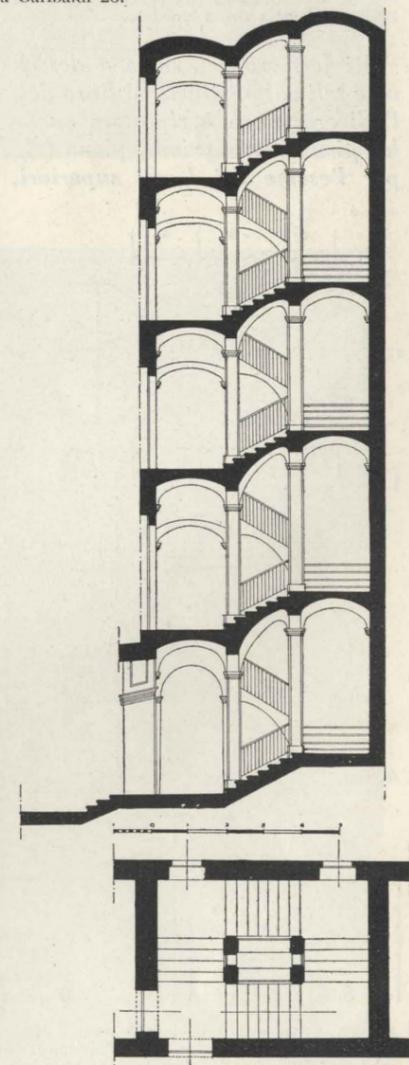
Sezione e pianta della Scala di casa Fontana di Cravanzana.
